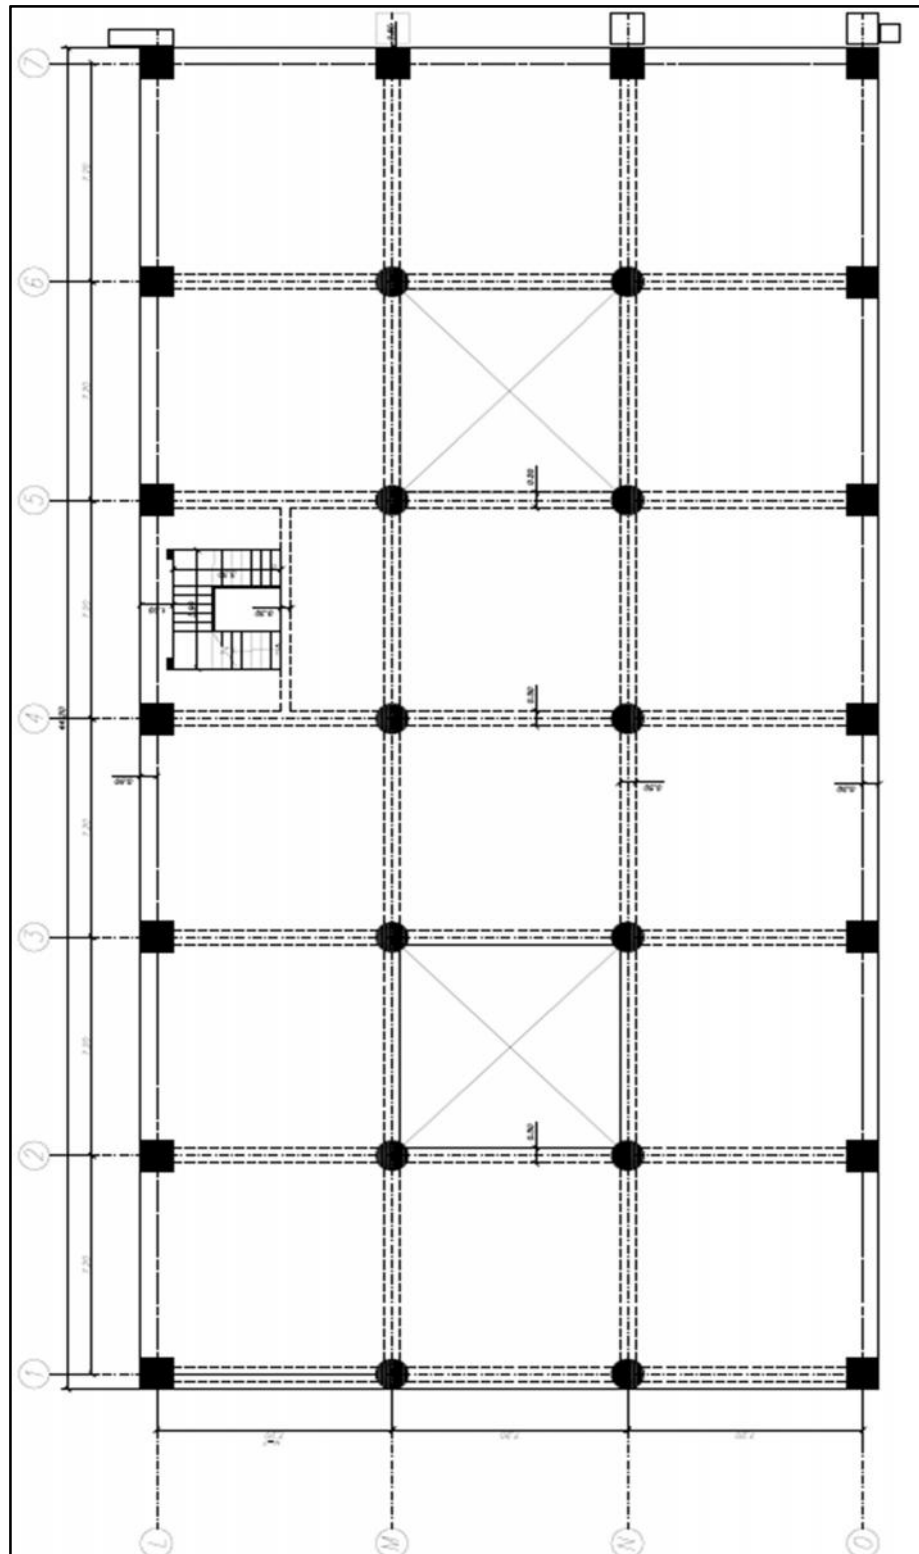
Planta estructural N+7.92, 11.88, 15.84, 19.80m; Gobernantes
